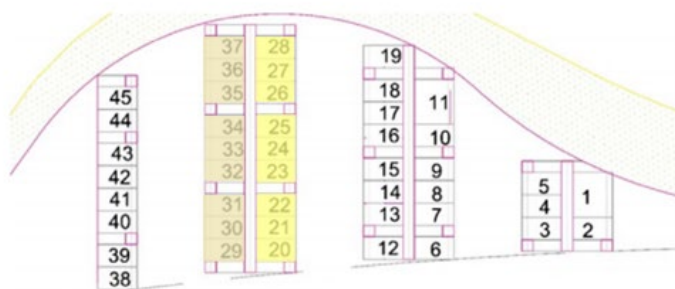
Plazas tipo (C) 20-28 y tipo (D) 29-37. Fuente propia
